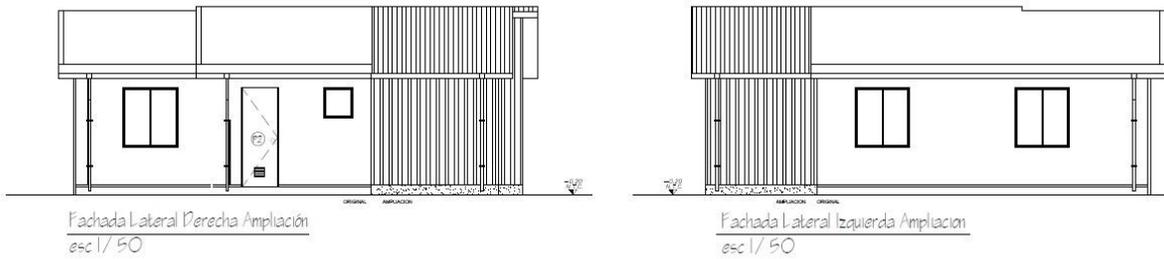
Planimetría Elevaciones Ampliación Vivienda Mejoradas
